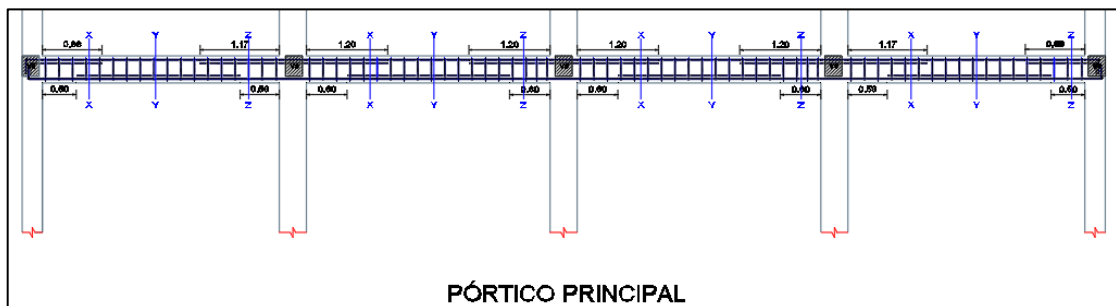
Detalle de acero corrugado en pórtico principal de concreto armado
